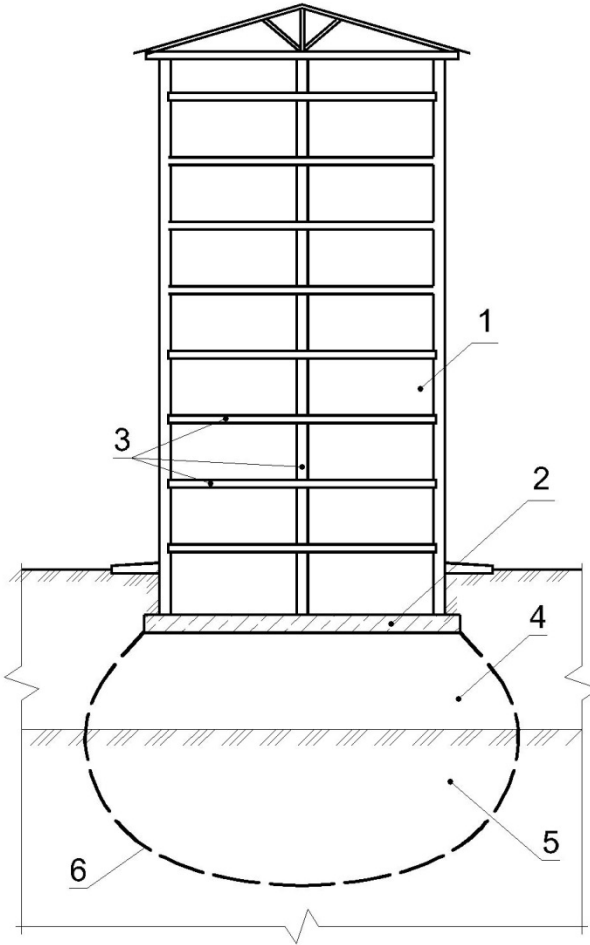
Система «основание – фундамент – надземные строительные конструкции», используемая для оценки работы и проектирования многоэтажного здания:
